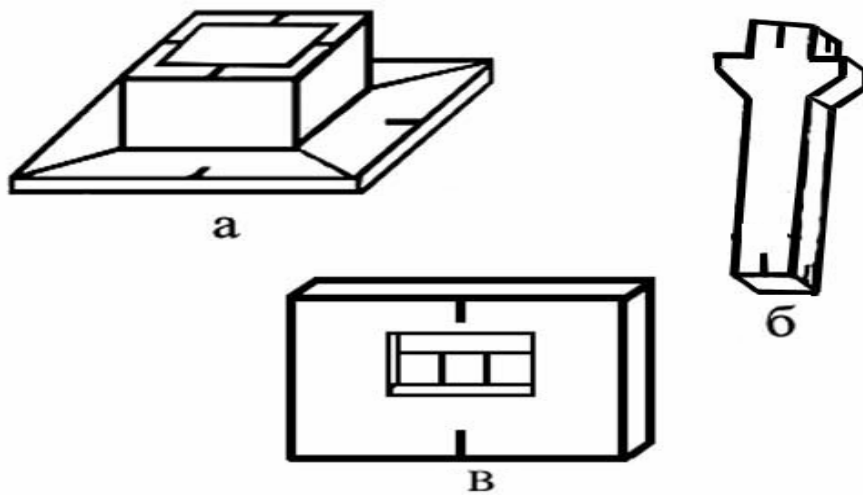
Приклади нанесення рисок осей симетрії на елементах будівельних конструкцій: а – фундаментний блок; б – залізобетонна колона; в – стінова панель.
